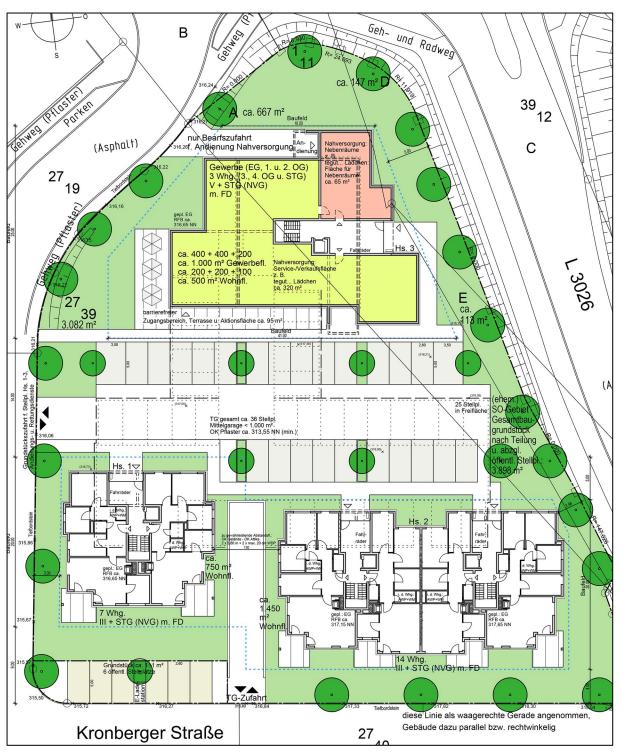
Lageplan der geplanten Bebauung (vorläufiger Planungsstand – Konzept) - Quelle: Firma Bücher, Idstein
